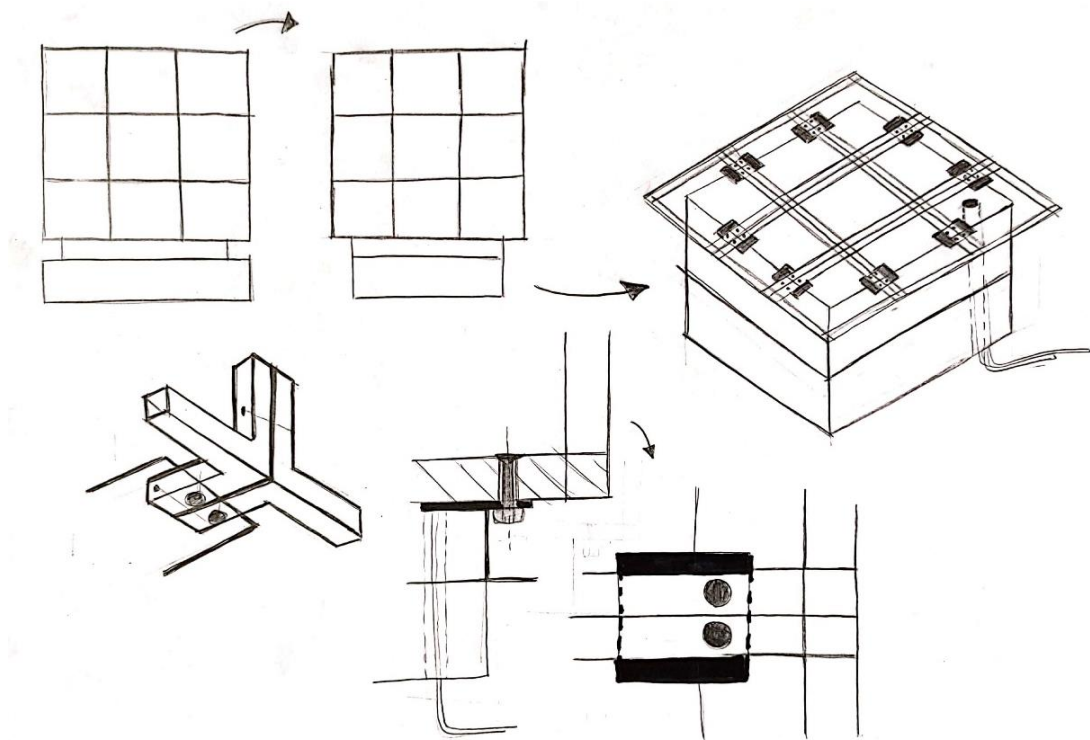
Croquis explicativo del sistema de cimentación para LockIt Rubik&Go - Elaboración propia
